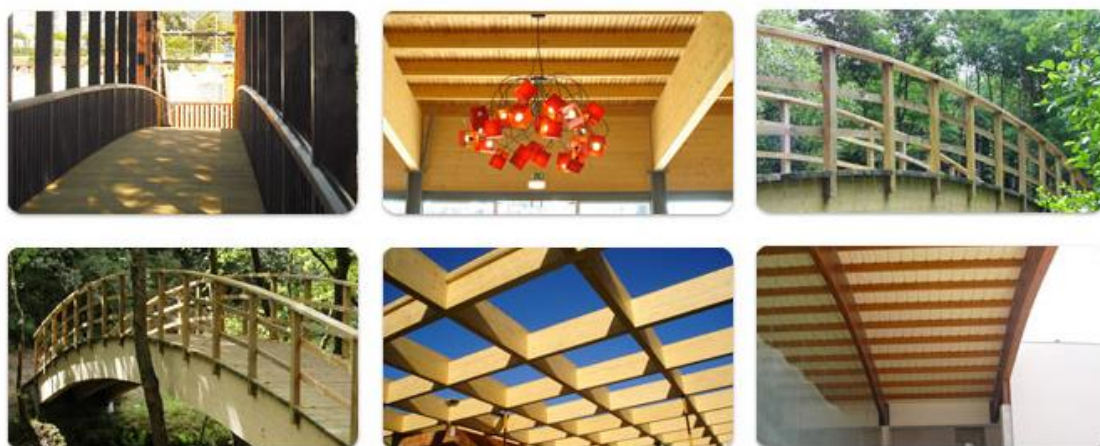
Exemplos de aplicação da madeira lamelada [30].
